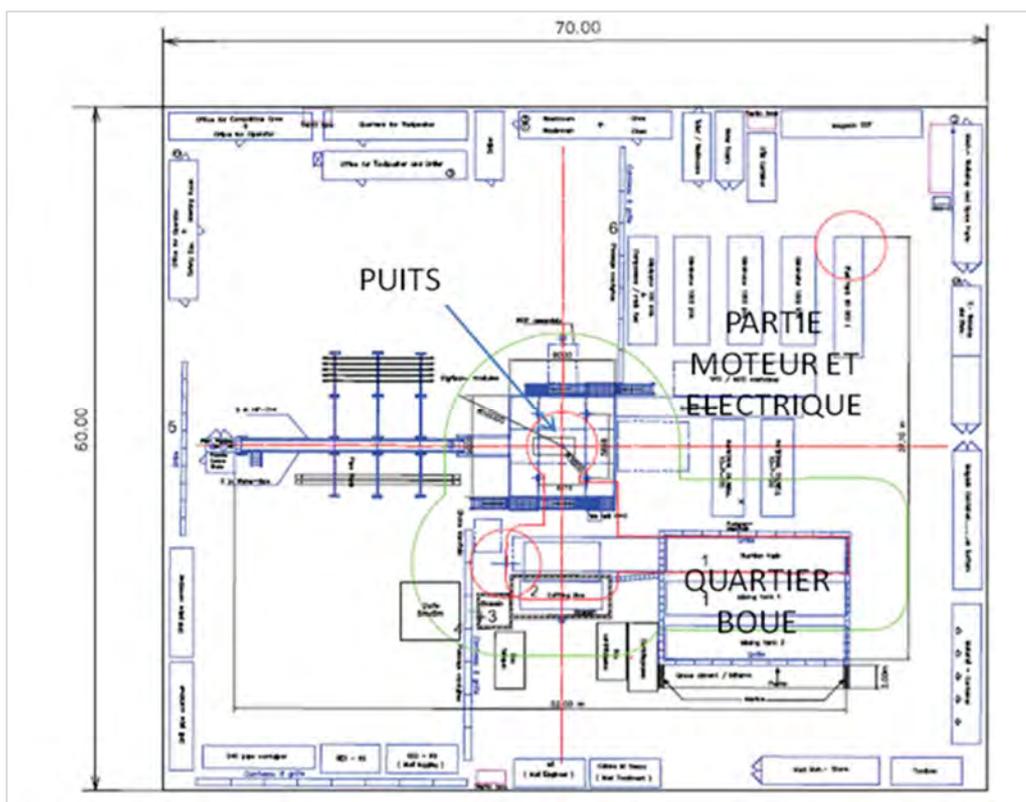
Schéma type d'implantation d'un chantier (source : Storengy)
